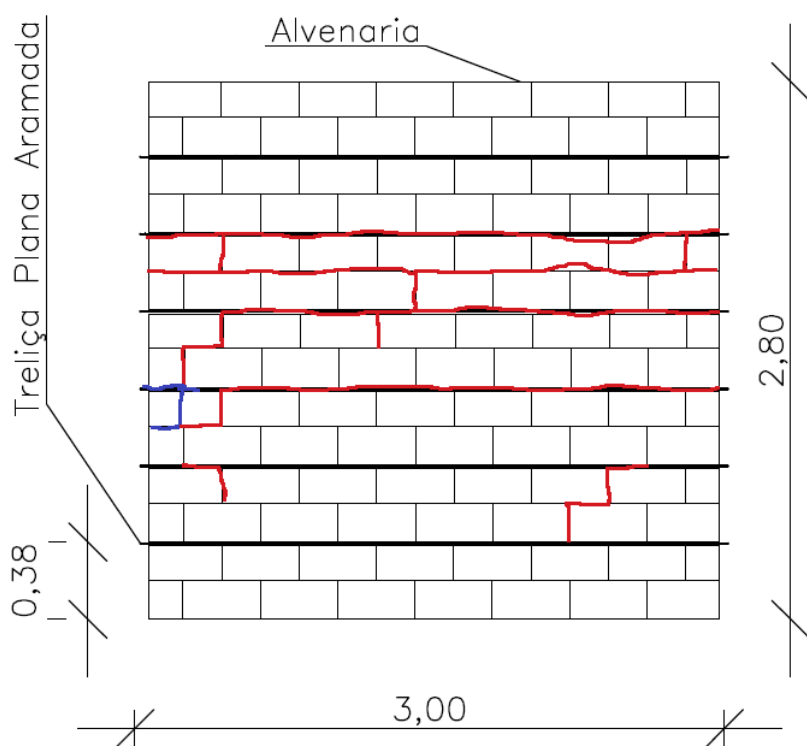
Mapeamento de fissuras da primeira alvenaria ALV – 4 (Vista posterior)
